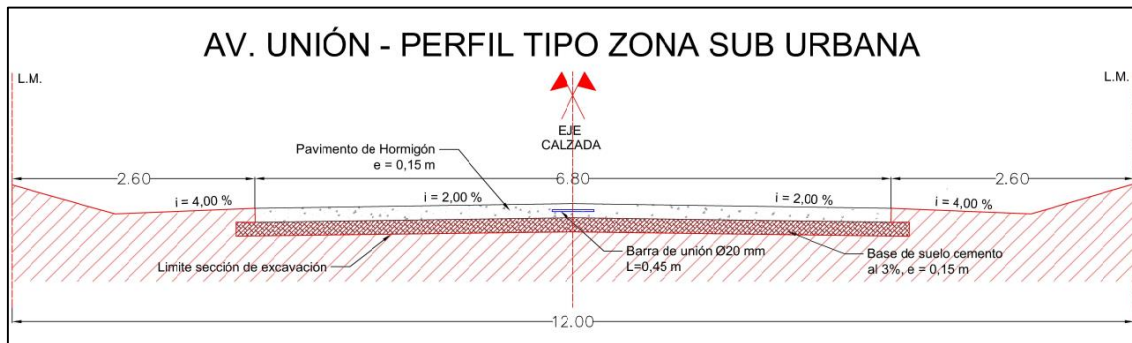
Sección transversal tipo de la Av. Unión en zona sub-urbana
